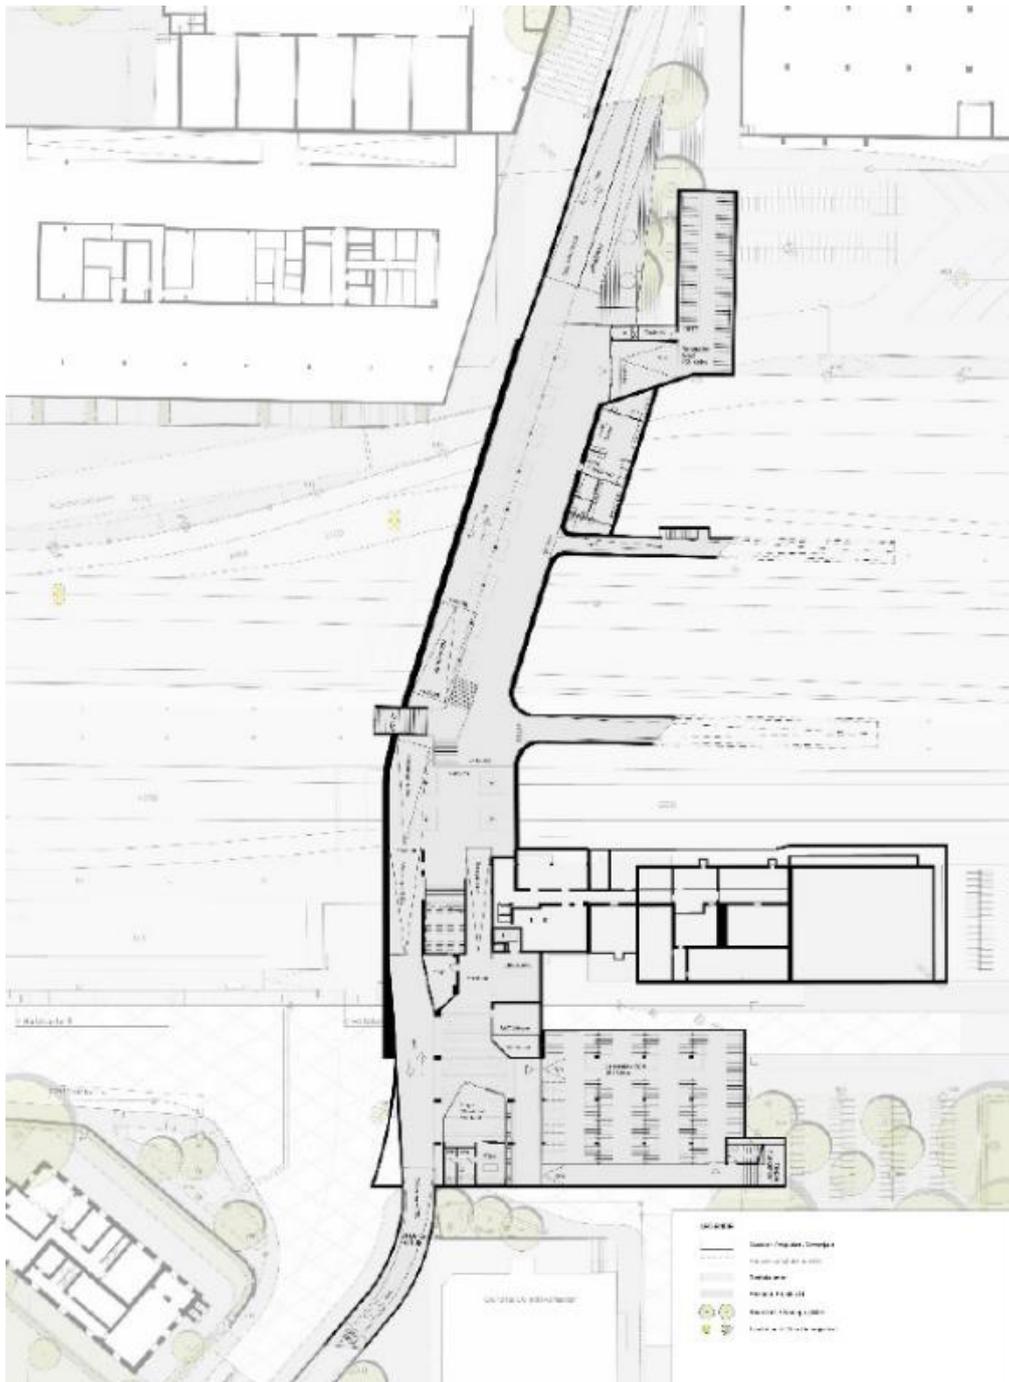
Bauprojekt Grundriss der neuen Bahnhofspassage als Stadtverbindung
